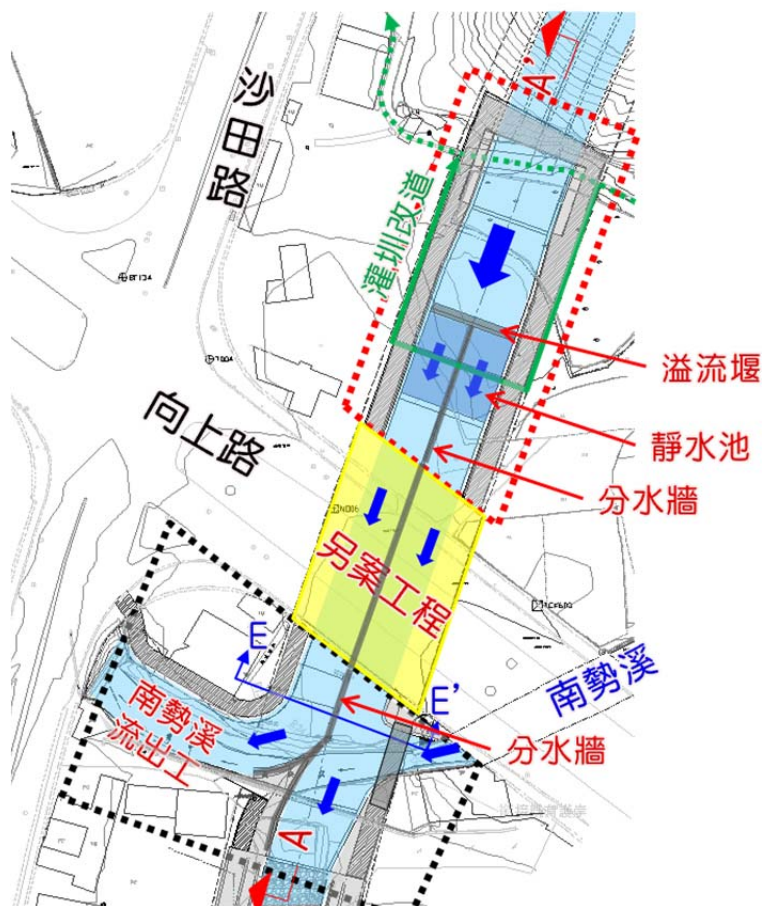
南勢溪急流分流工設計平面圖(方案一)
